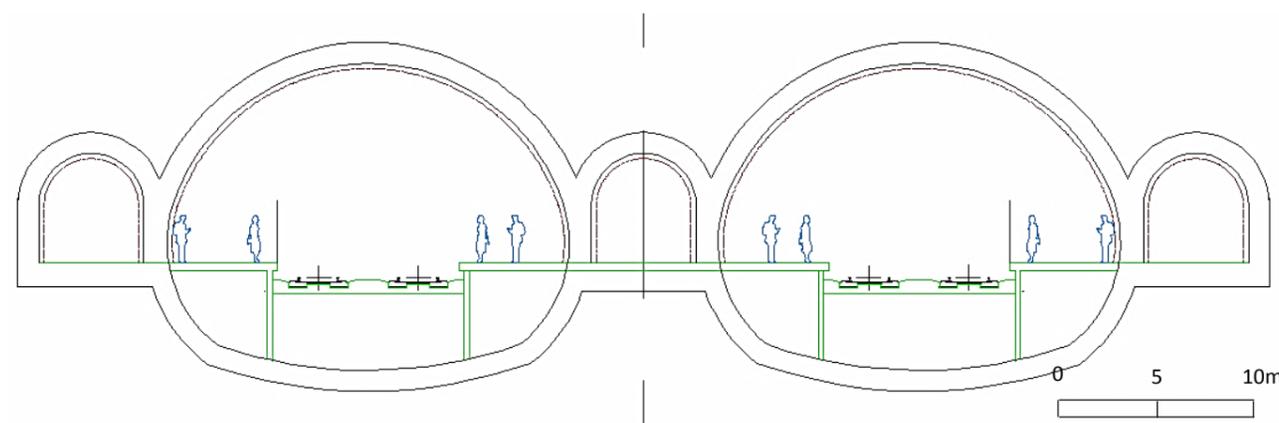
Section à double voûte étudiée pour la gare Lille-Flandres
